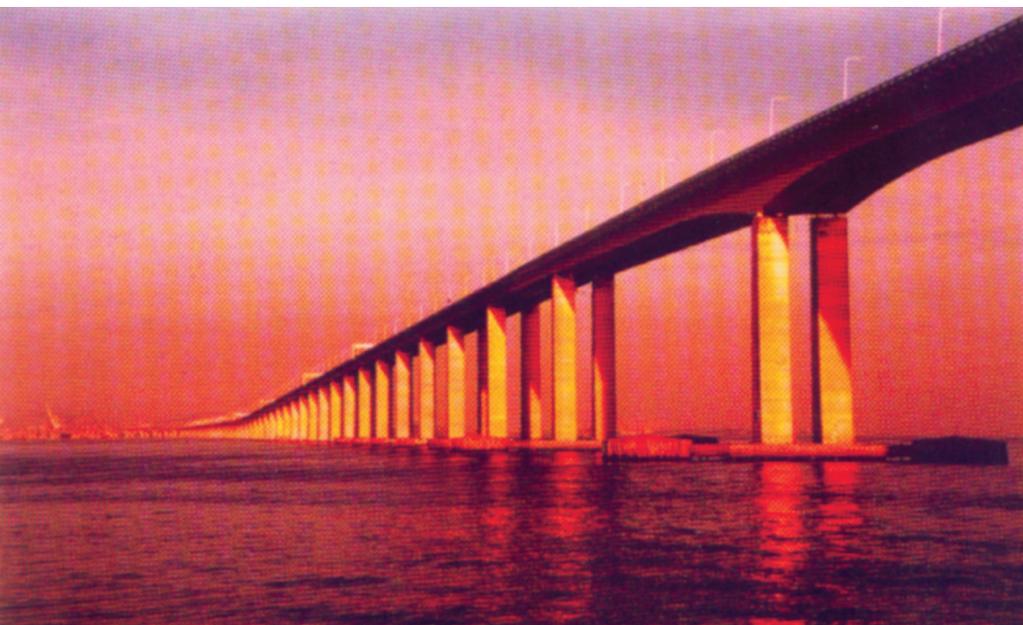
ARQUITETURA UNIFORME AO LONGO DE TODA A PONTE
